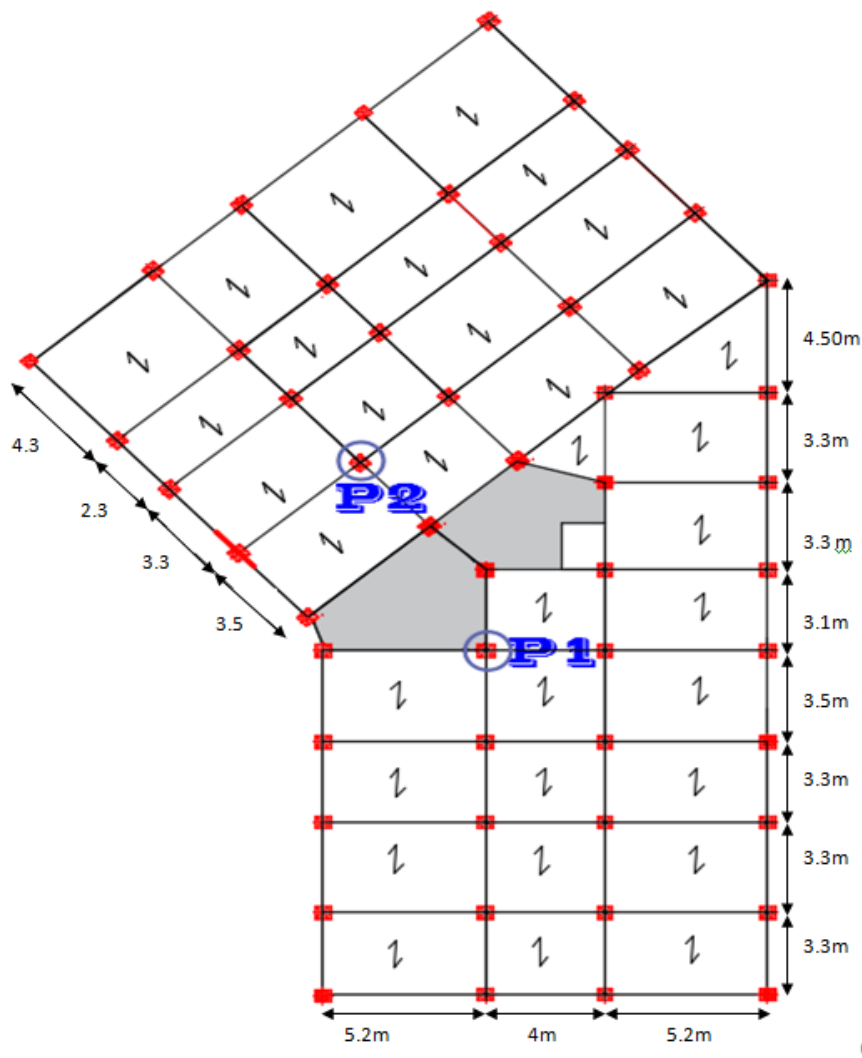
Disposition des poutrelles planchés RDC et Entre-sol
